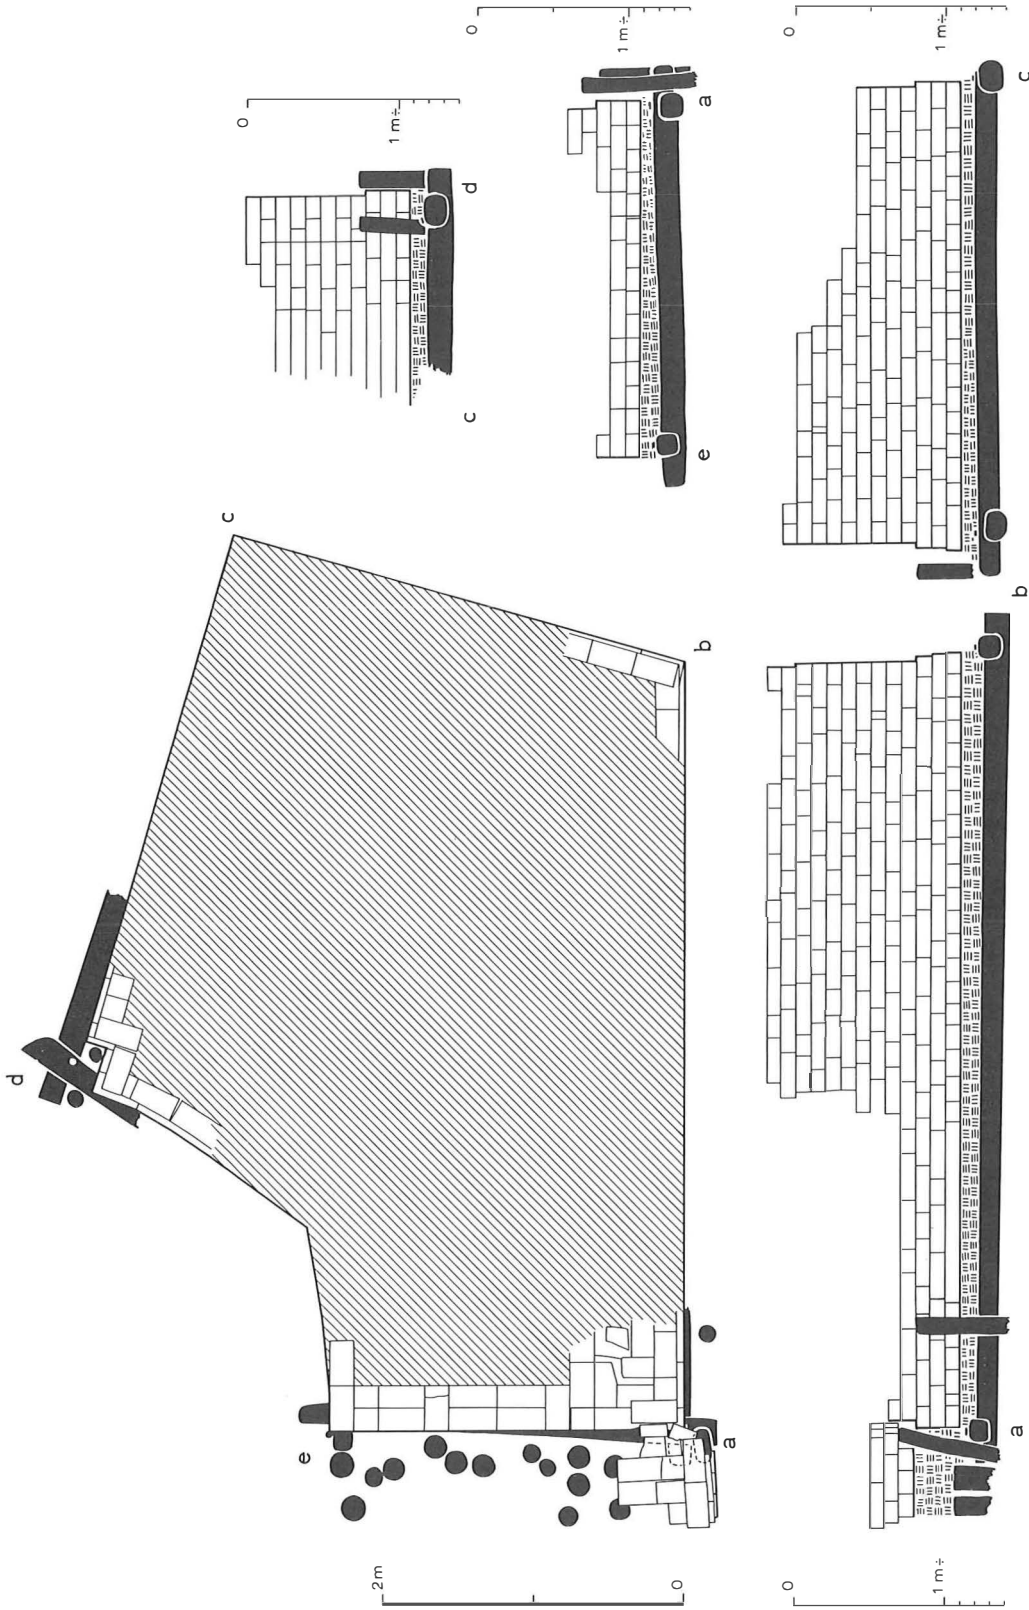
St. Bernardusabtei Aduard. Hochchorschluss, nördlicher Kopf der Sockelmauer. Grundriss und Ansichten.
